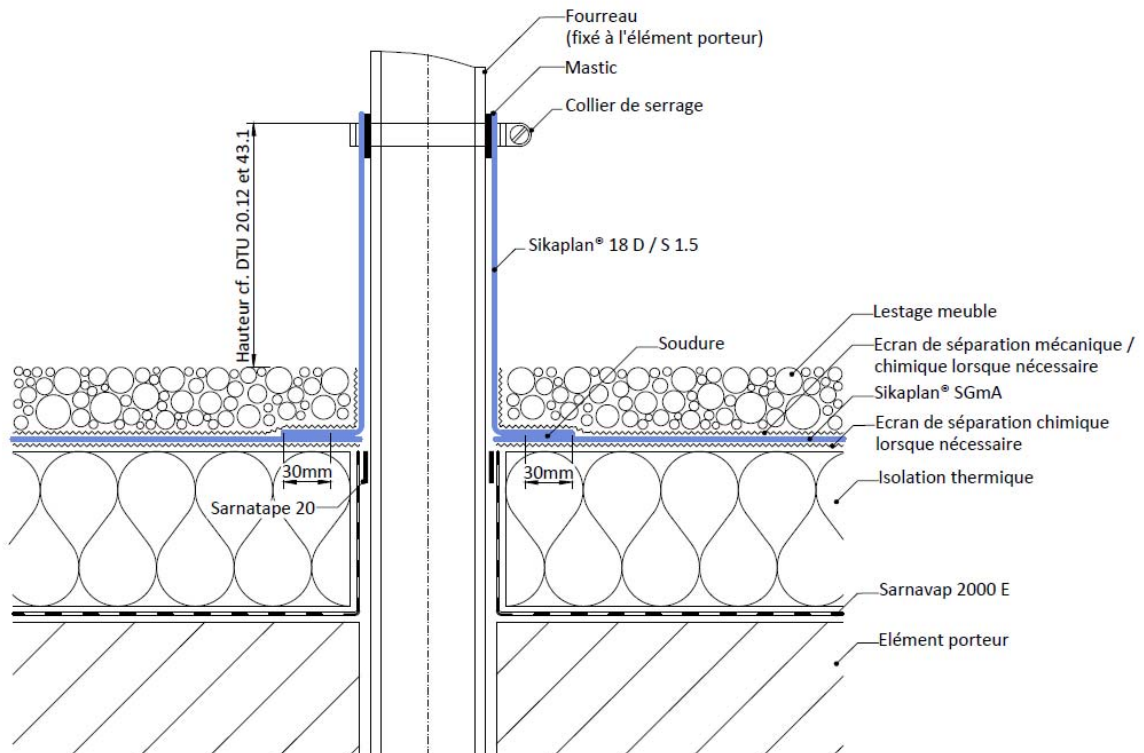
Traversée de toiture - Élément porteur avec état de surface « lissé » au sens du DTU 21
